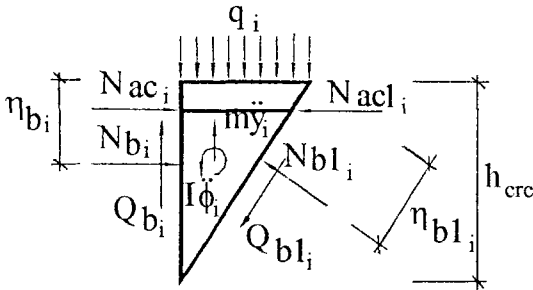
Схема внутренних усилий в треугольном элементе над наклонной трещиной.
